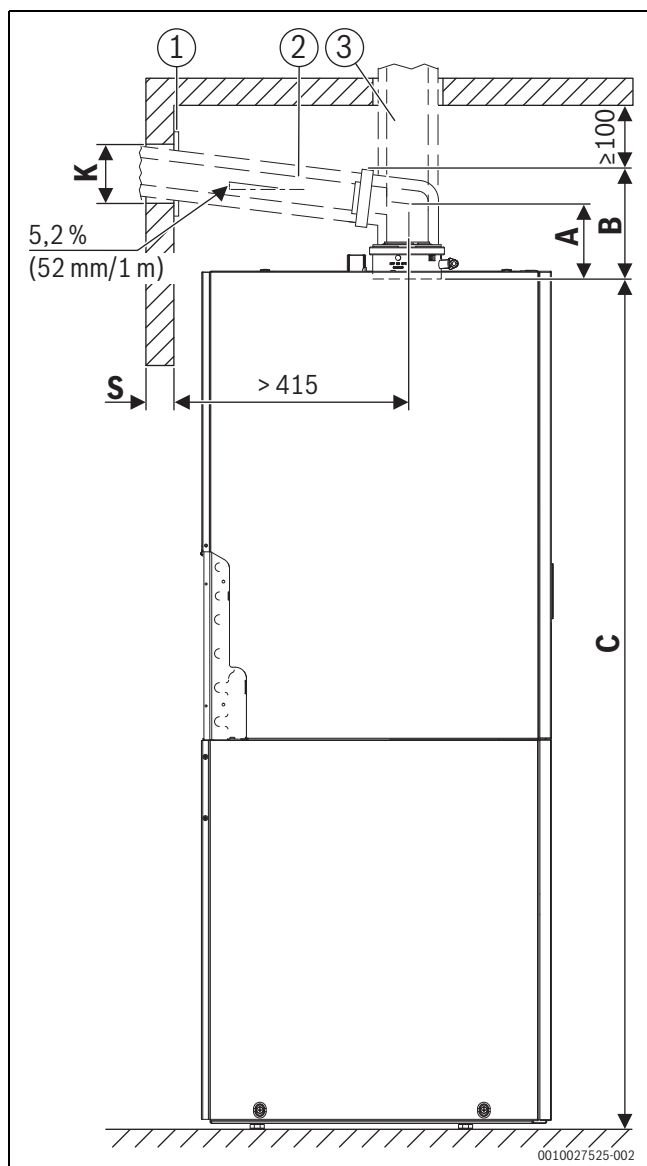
Vedere de pe partea stângă (dimensiune în mm)
